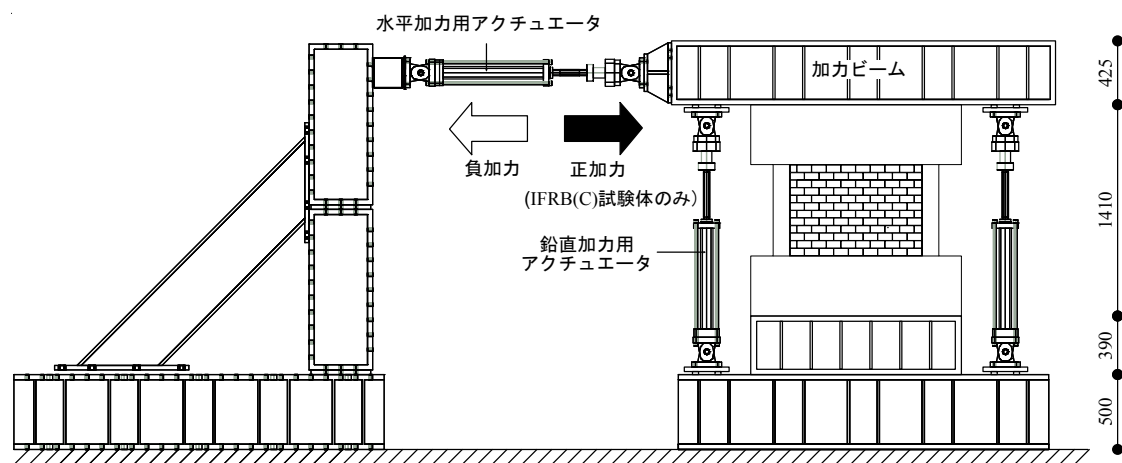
IFRB 試験体の載荷システム (単位 : mm)
